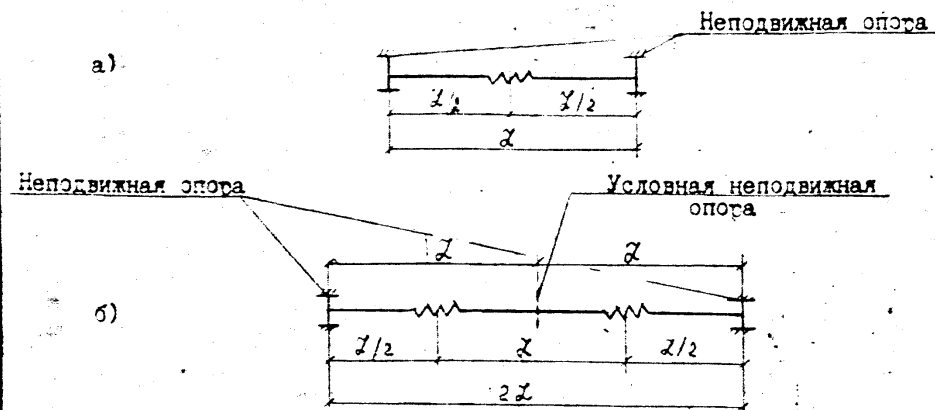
Схемы установки сильфонных компенсаторов при бесканальной прокладке теплопроводов:
